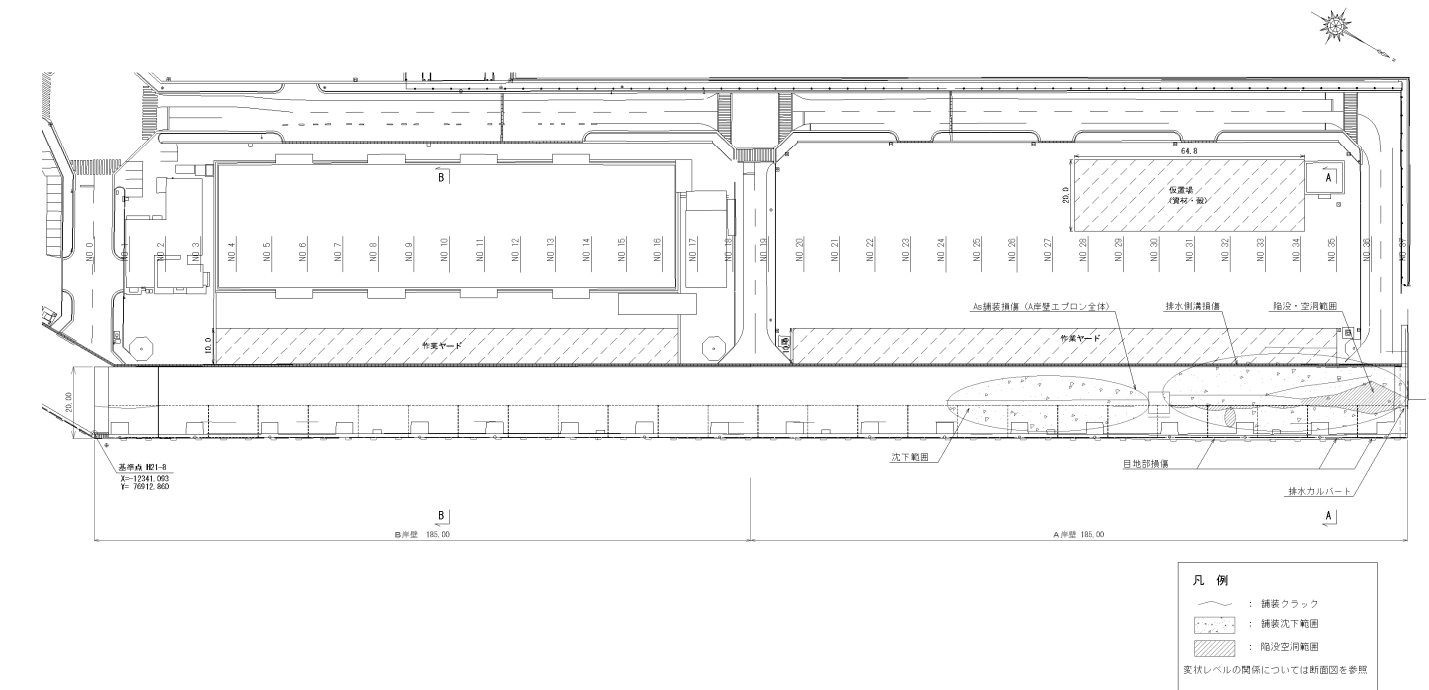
87 No. 4 南公共ふ頭 B 岸壁(-10m) 平面図（被災後）
